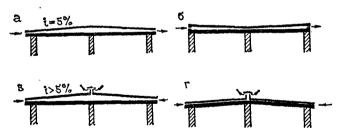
Бесчердачное невентилируемое покрытие с легкобетоиными несущным панелями
